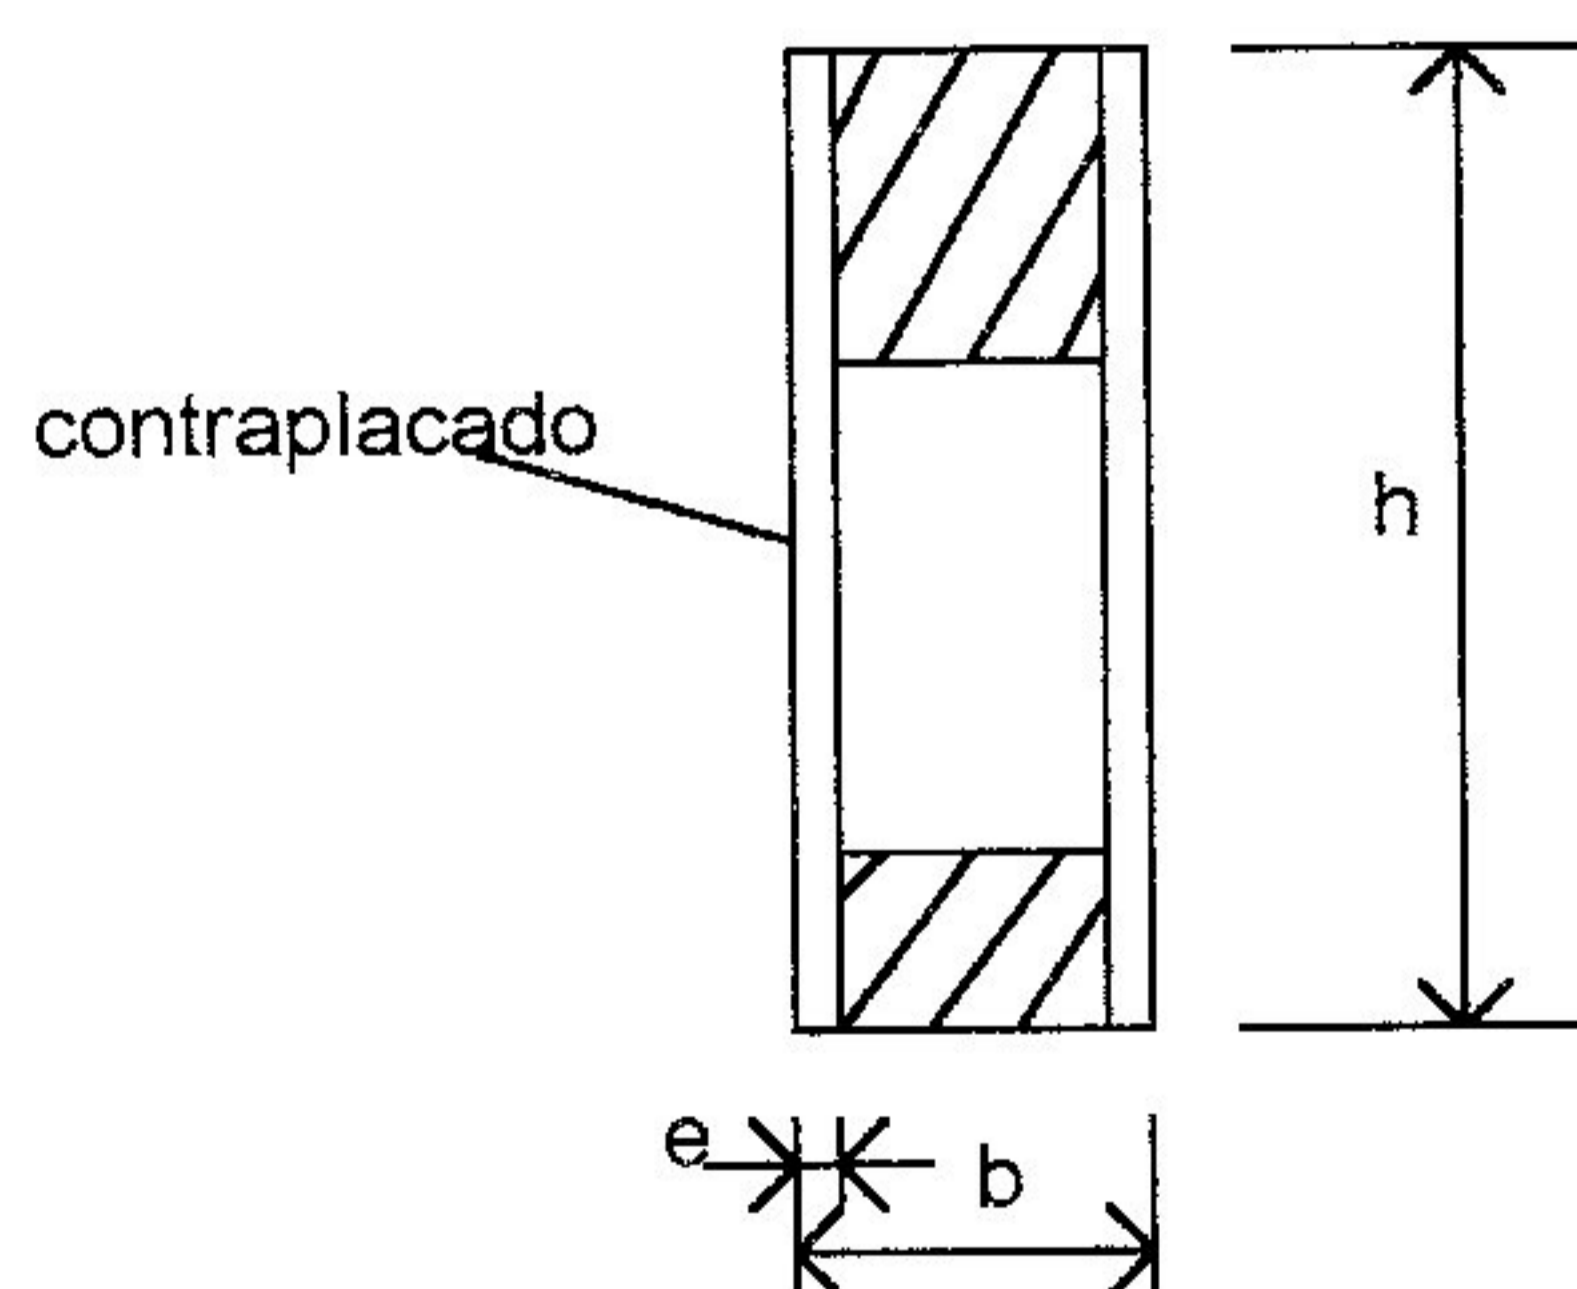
Seção Transversal de uma Viga de Madeira Tipo Caixão
